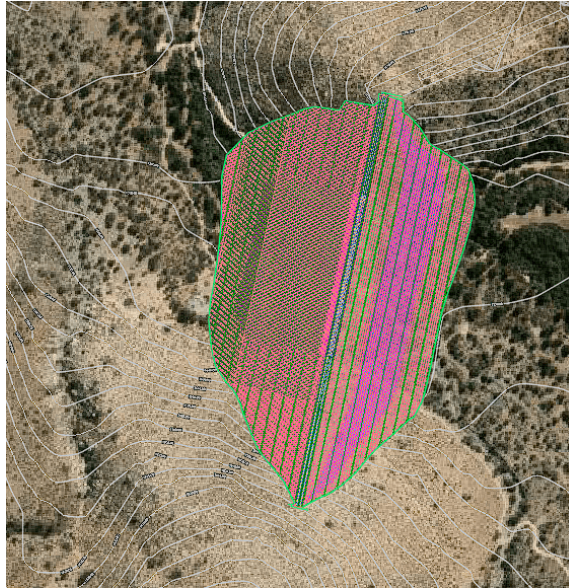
Proyección presa de CFRD Murallas Viejas, Civil 3D
